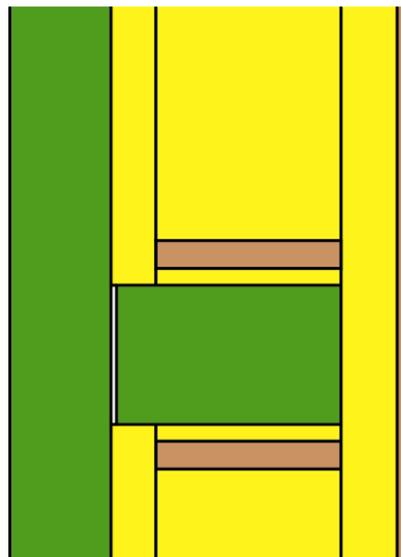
Horizontalschnitt Bereich Säule Ausführung
